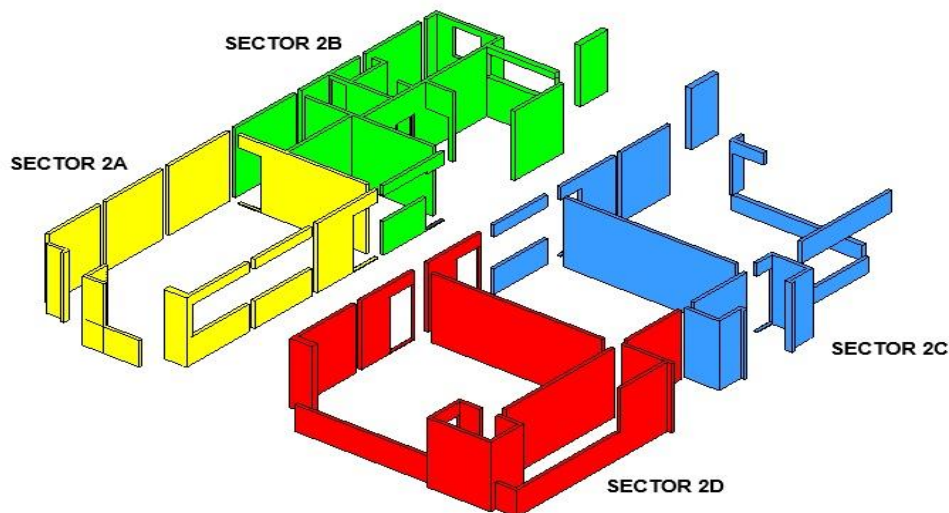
Vista en 3D de la sectorización – Elaborado en Revit Autodesk (2018)
